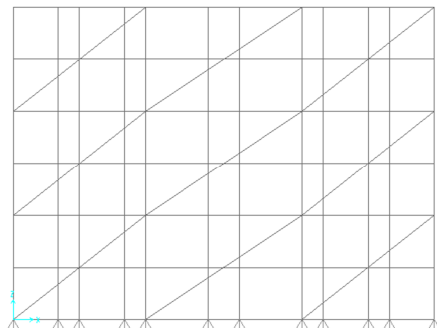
Configuração dos Planos de Contraventamento Vertical Com Elementos de Contraventamento Grandes
